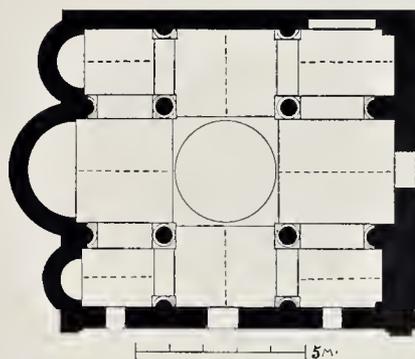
PLAN DE L'ÉGLISE SANT'ANDREA, A TRANI.
